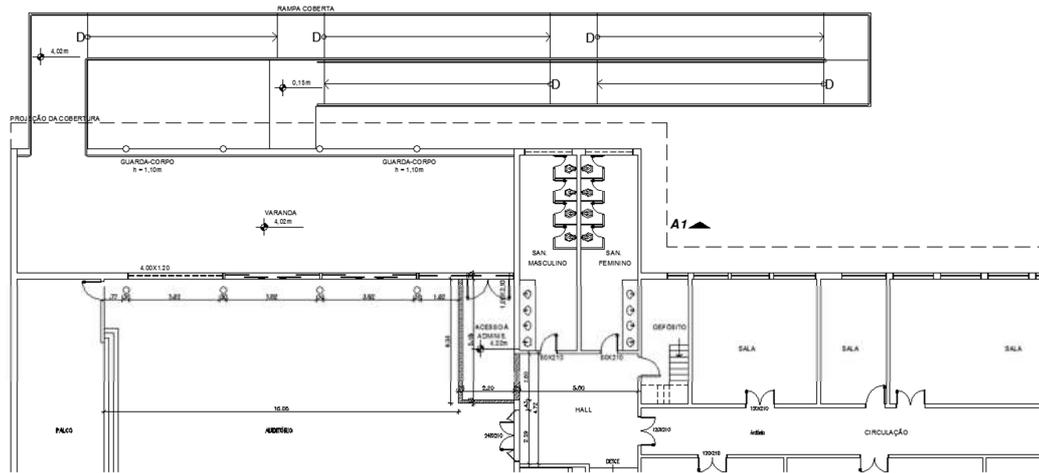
PAVIMENTO SUPERIOR - BLOCO ADMINISTRATIVO – CAMPUS PLANALTINA
